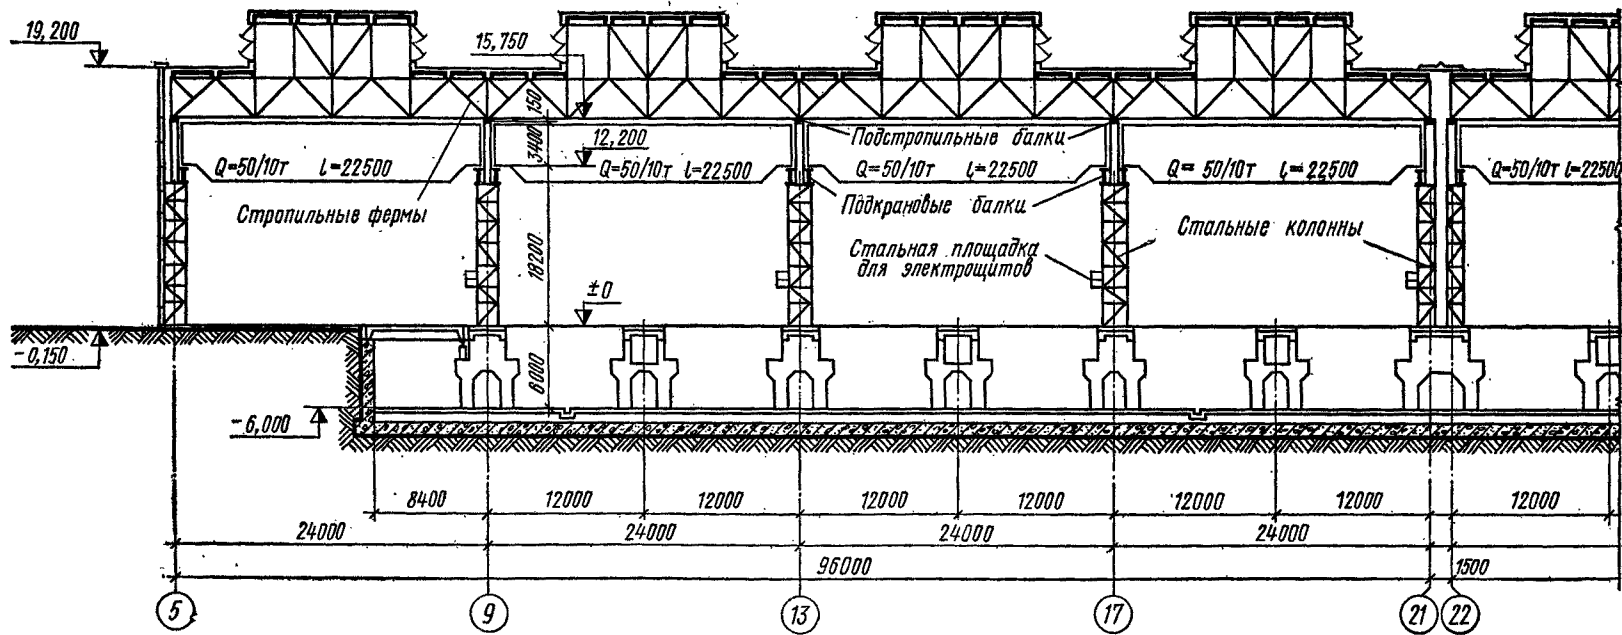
Фрагмент продольного разреза прессового корпуса ВАЗ
